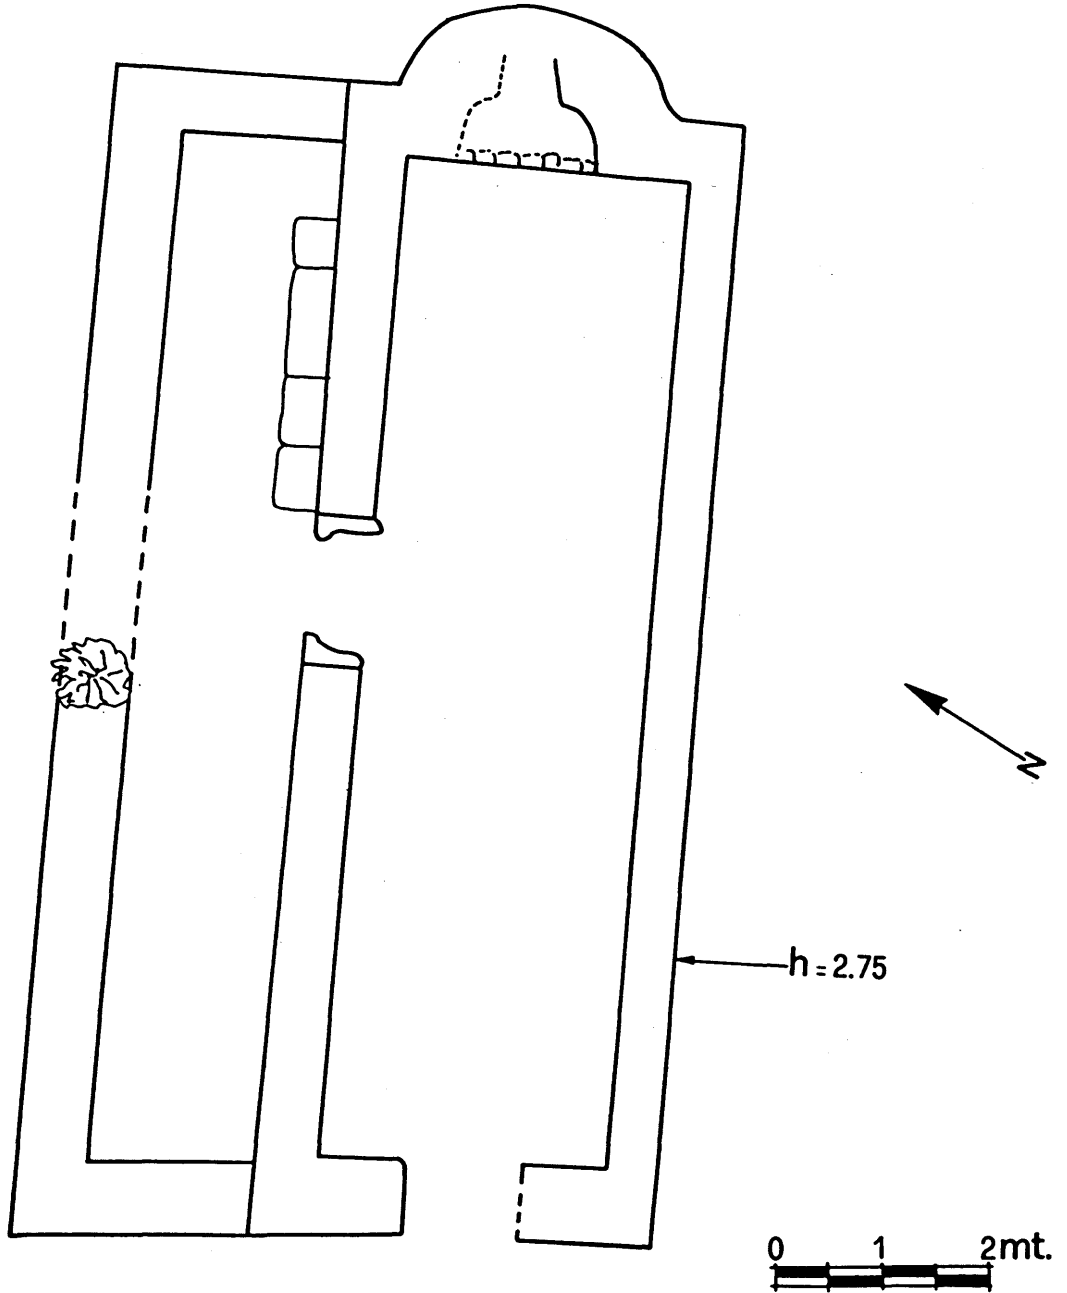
Chiesa di Santa Ippolita 'e Ziccori: planimetria.
